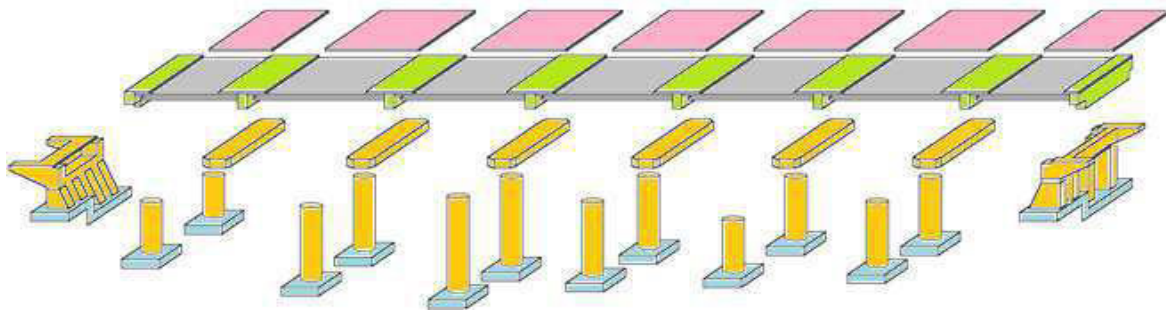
VRSG – Pormenor pré-lajes e vigas pré-fabricadas
